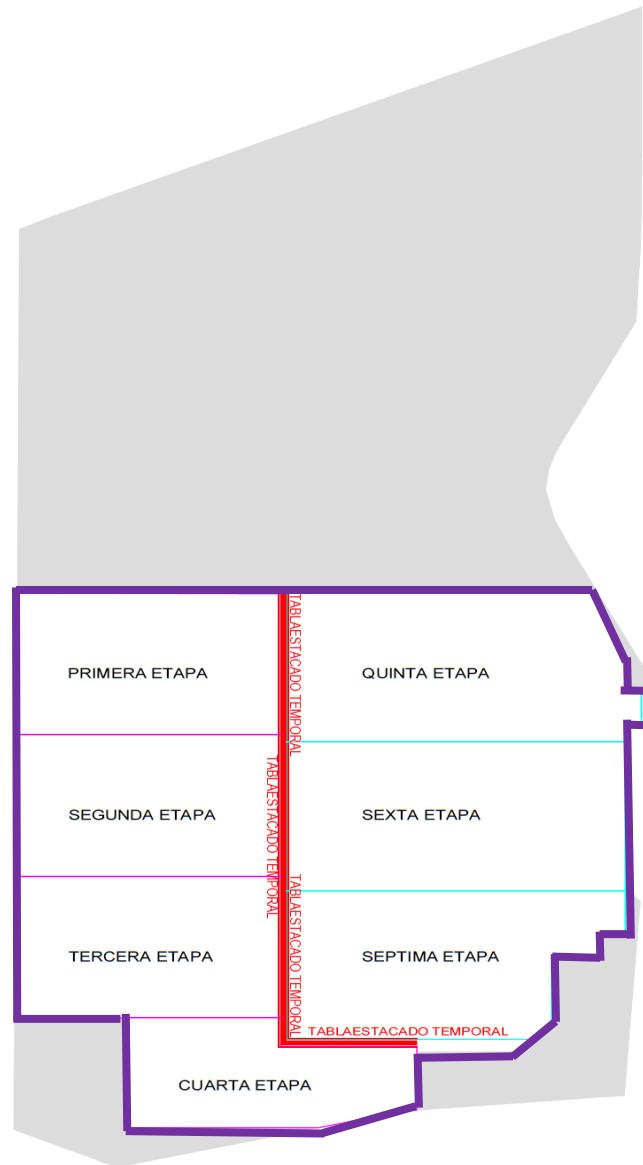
Tablestacado temporal y sembrado del muro Milán
